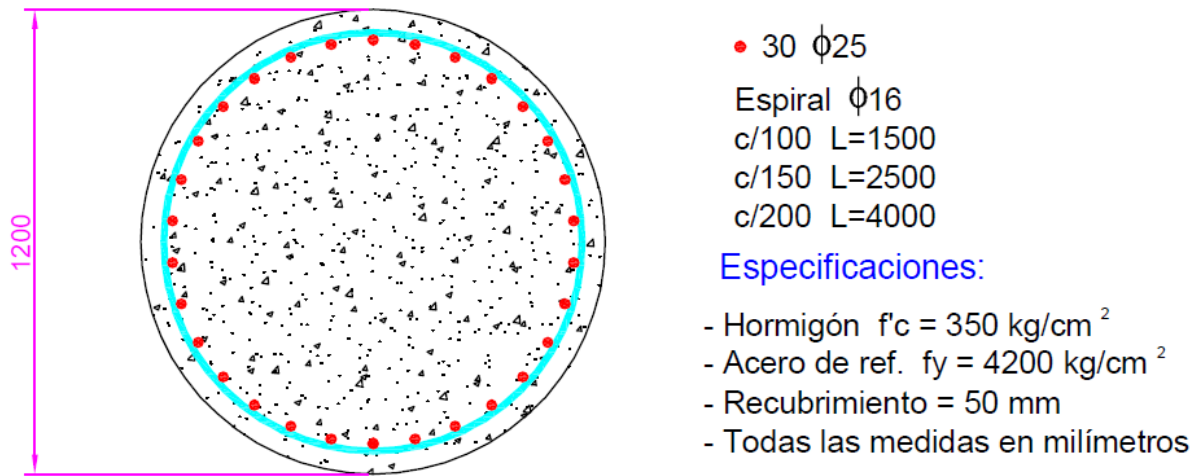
Distribución de acero de refuerzo en columna de la pila – ejemplo 3.1
